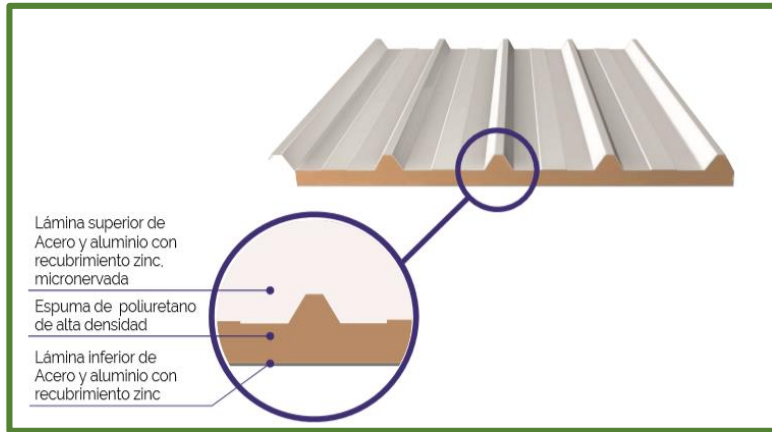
Esquema de cubierta tipo panel termo
